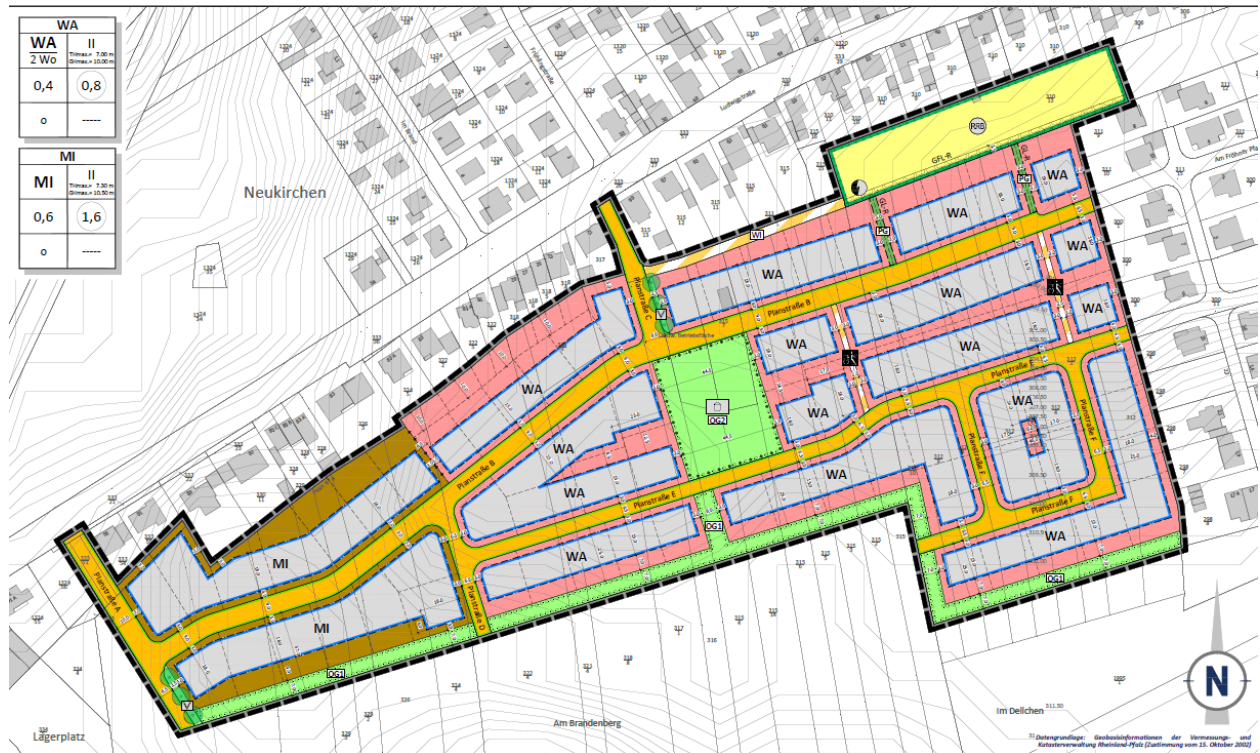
Entwurf des Bebauungsplanes "Erweiterung Im Dellchen"
